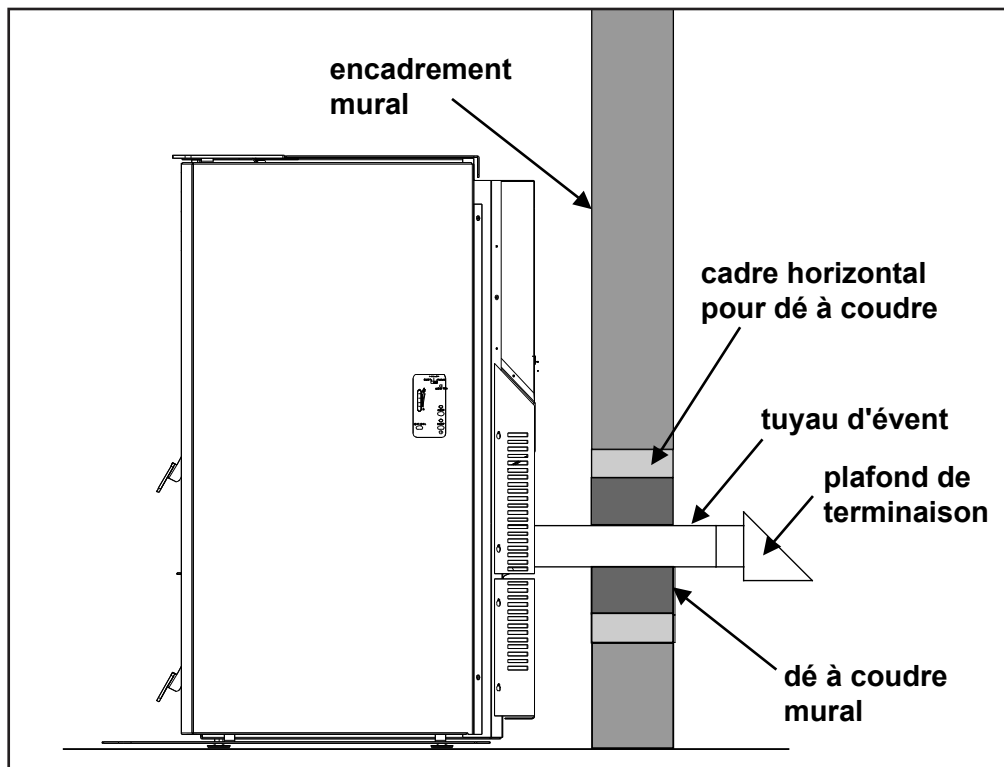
Tout Droit à Travers L'Installation de Mur - Vue de Côté.
